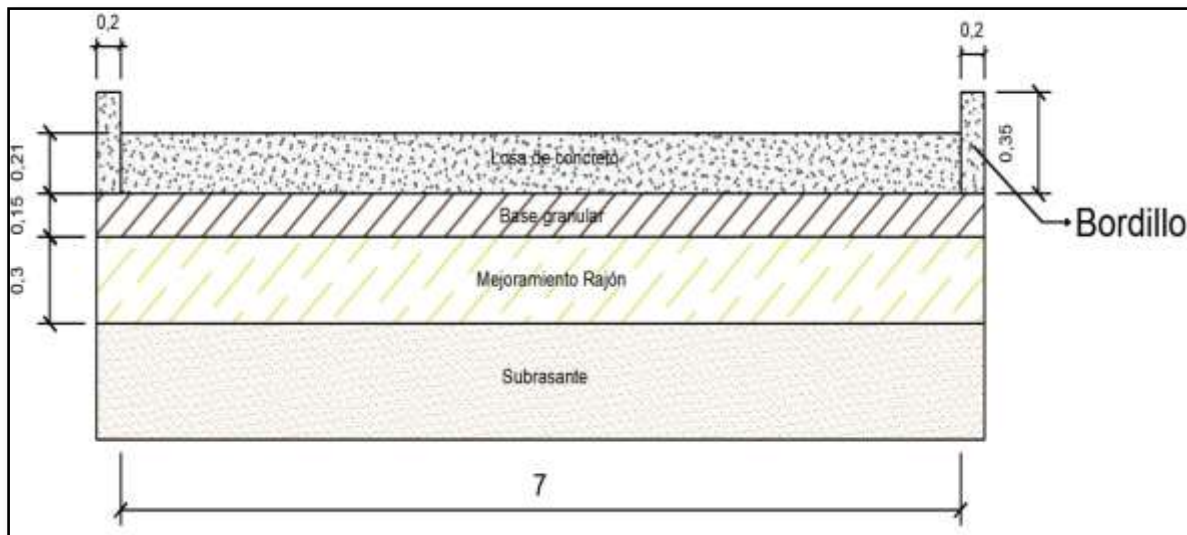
Estructura de Pavimento Rígido – Metodología PCA 84
